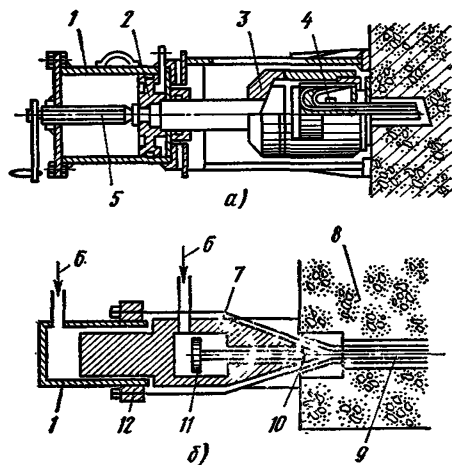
Гидродомкраты для натяжения арматуры на бетон:
